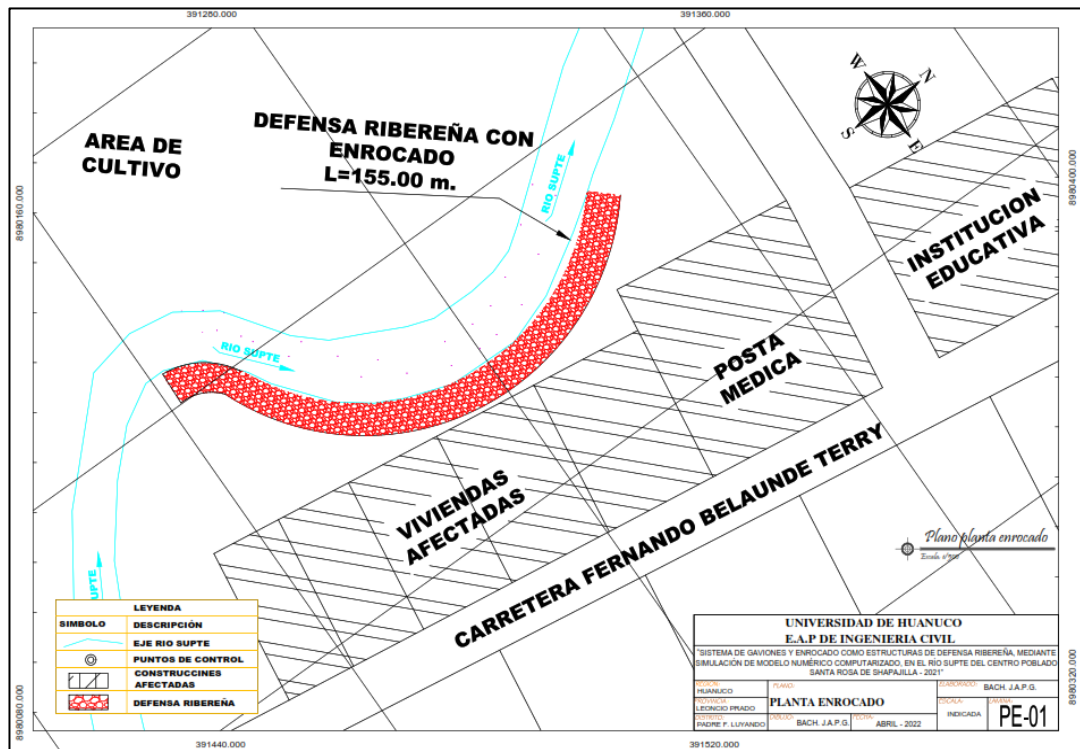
Vista en planta para el sistema de defensa con enrocado.
